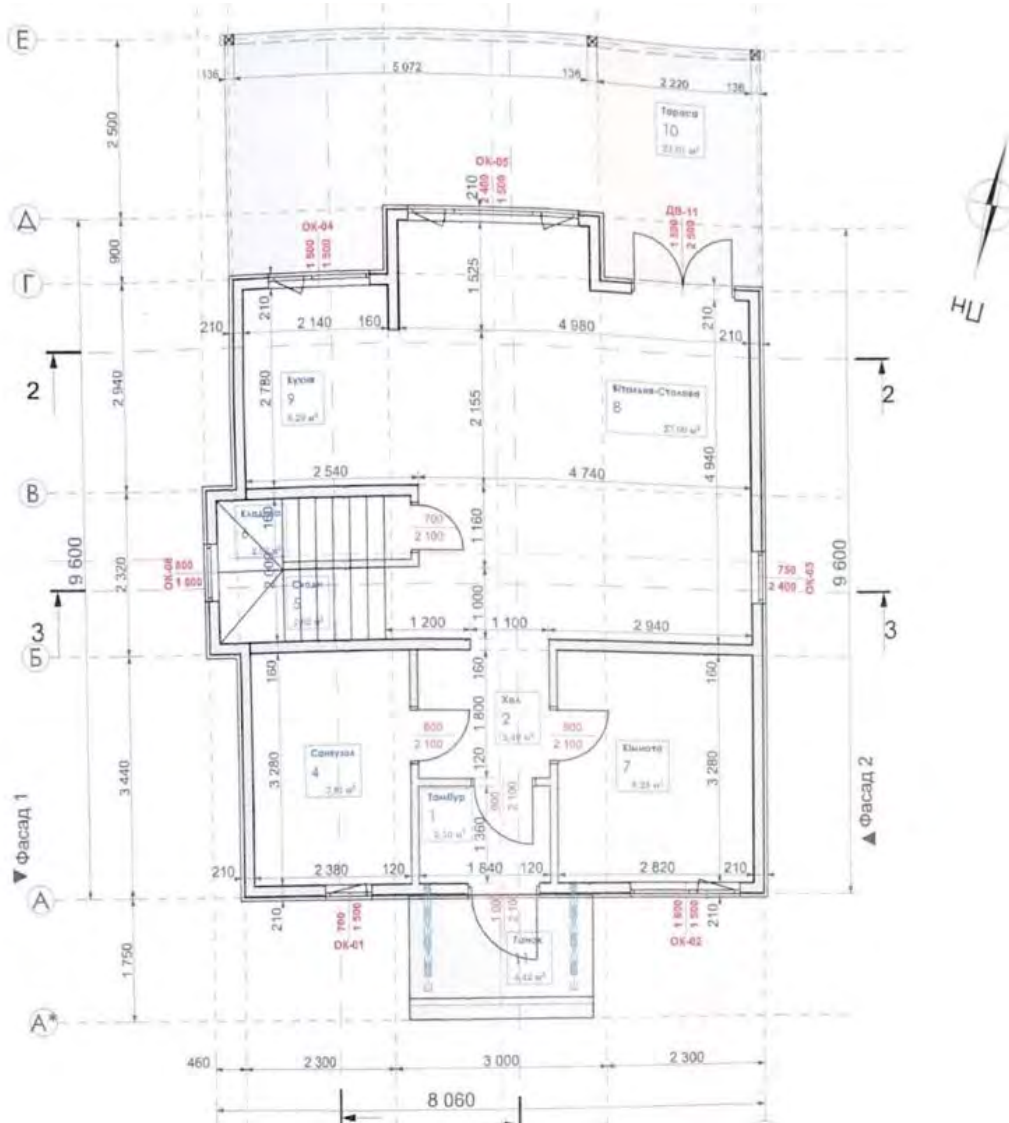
Кресленик першого поверху котеджу, реалізований в додатку SketchUp Layout
